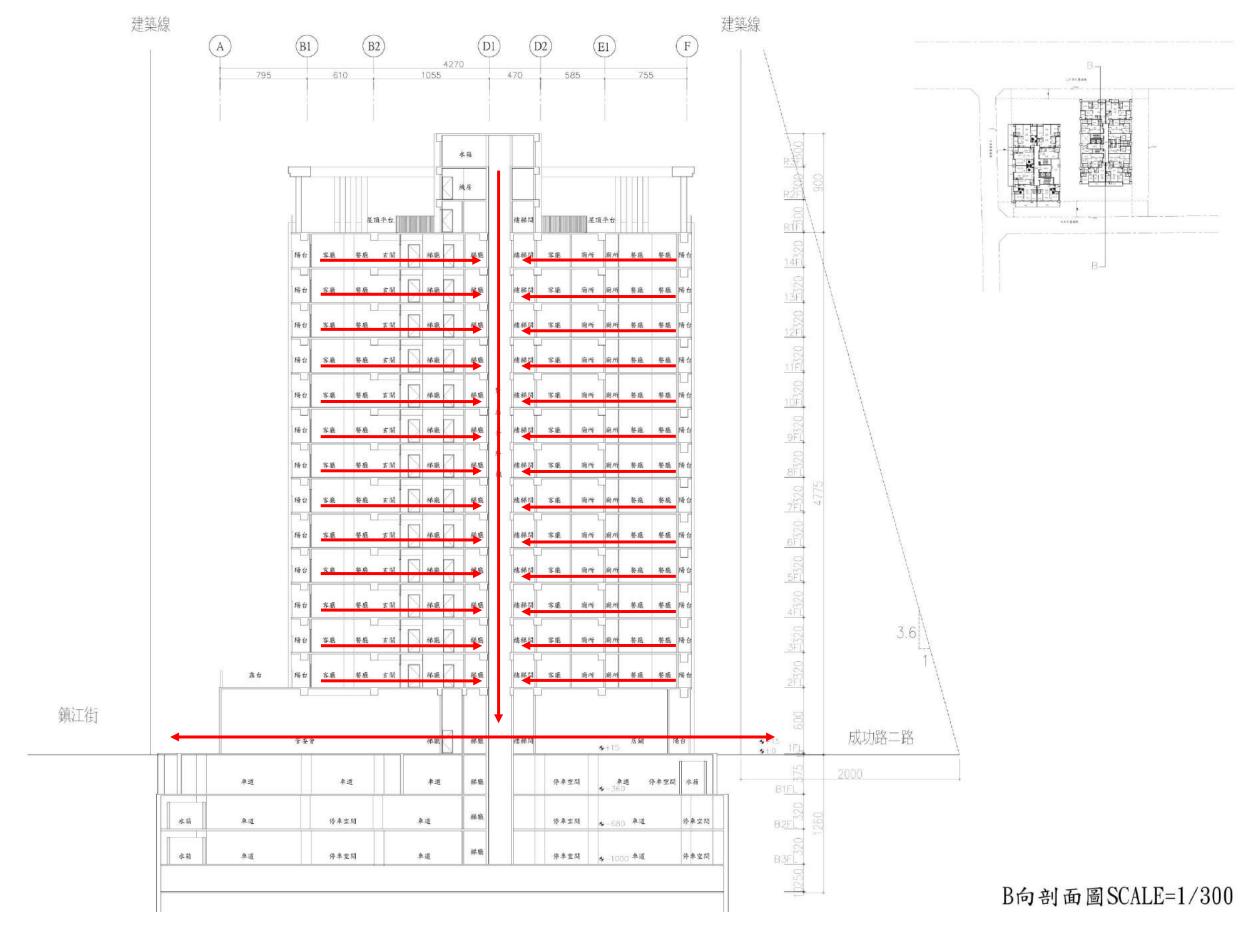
防災避難動線剖面示意圖 (S:1/300)
